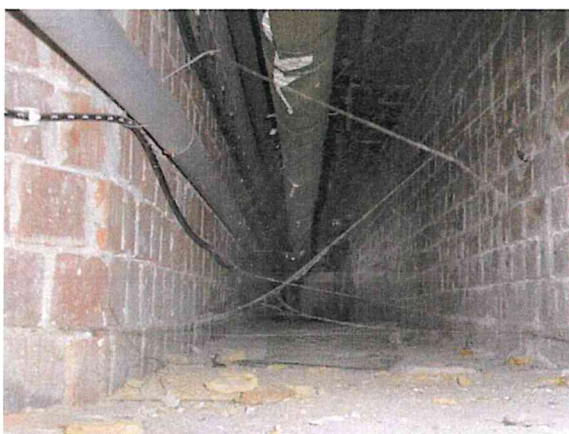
Schacht mit Leitungen (ebenfalls ohne Hinweise auf Tiere)
